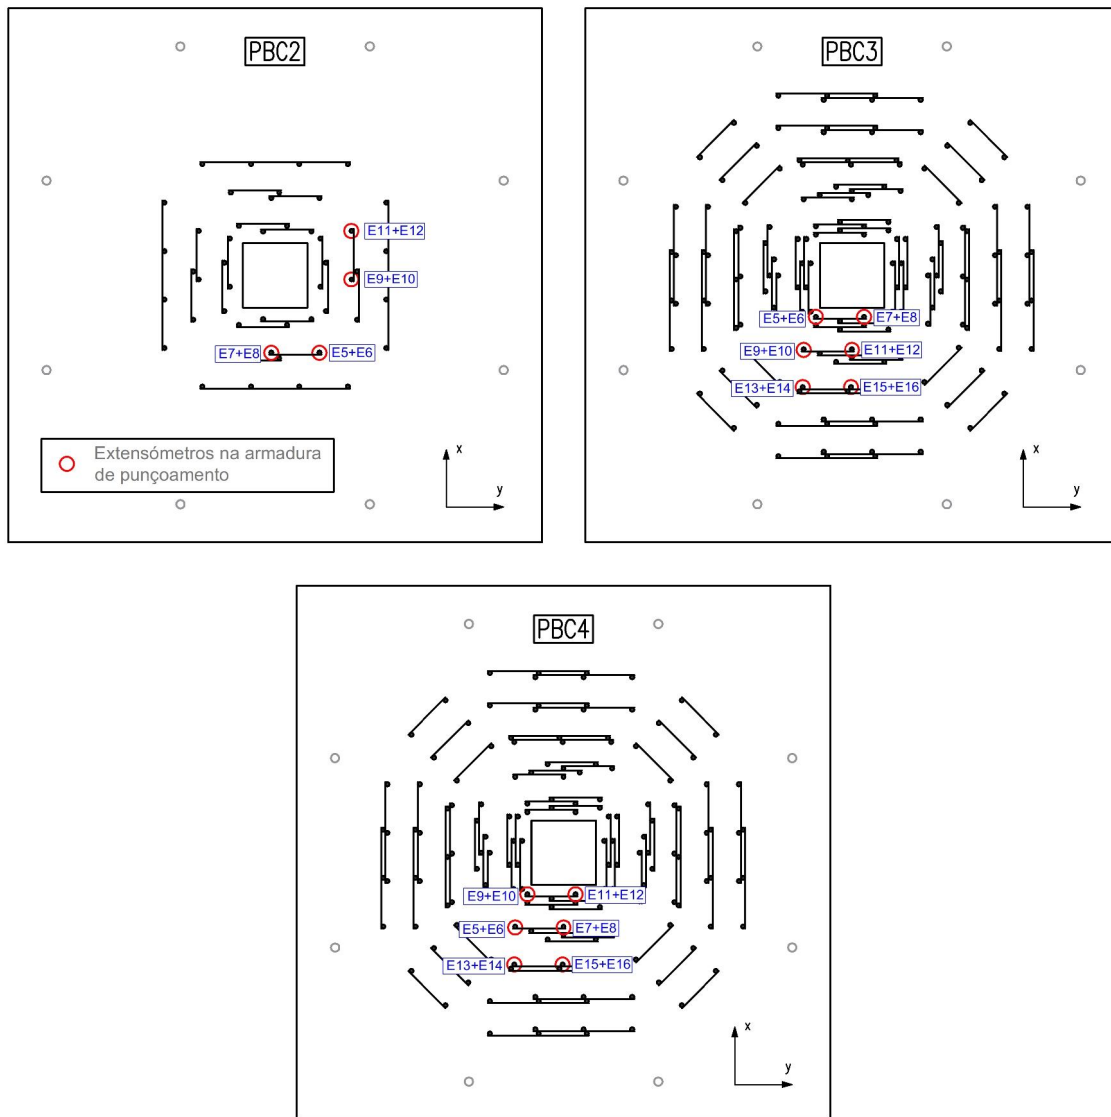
Localização e numeração dos extensômetros nas armaduras de punçoamento das lajes PBC2 a PBC4.
